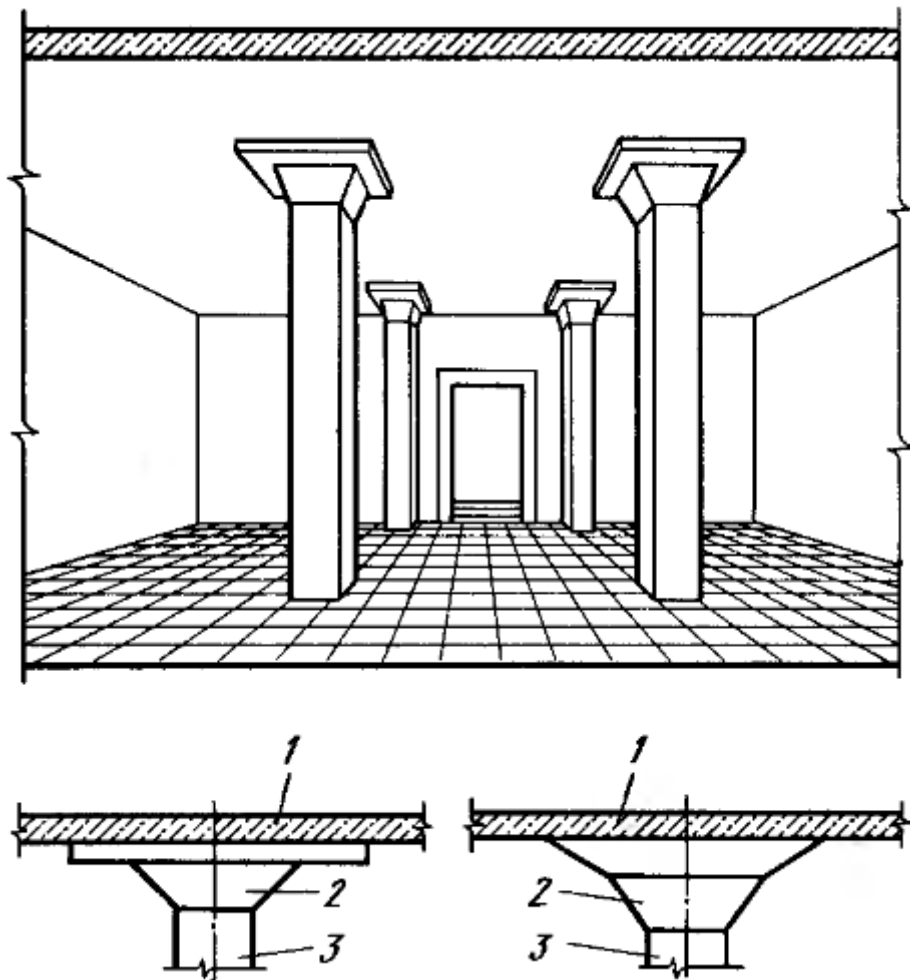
Безбалкове перекриття. 1 - плита перекриття, 2 - капітелі колон, 3 - колона
